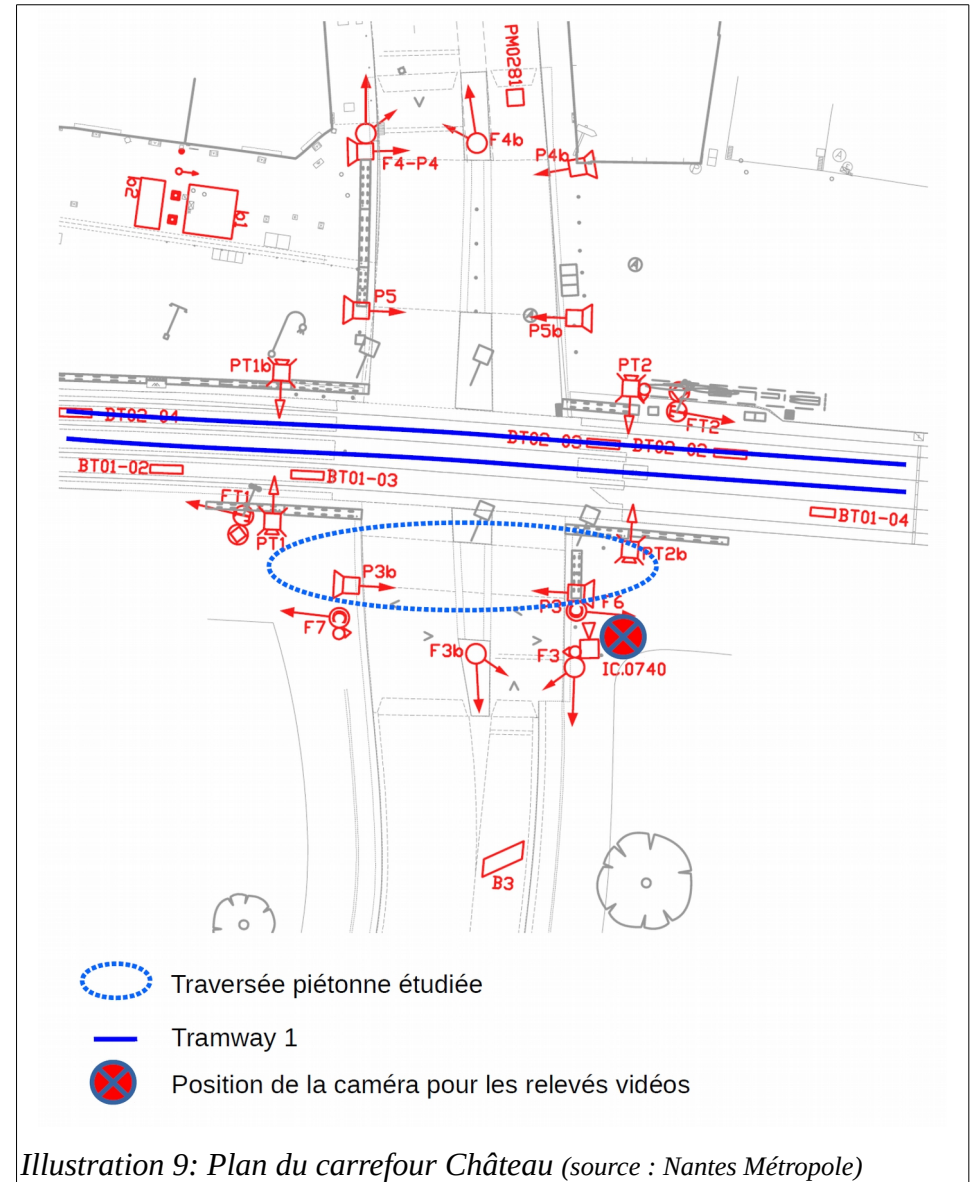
Plan du carrefour Château (source : Nantes Métropole)
